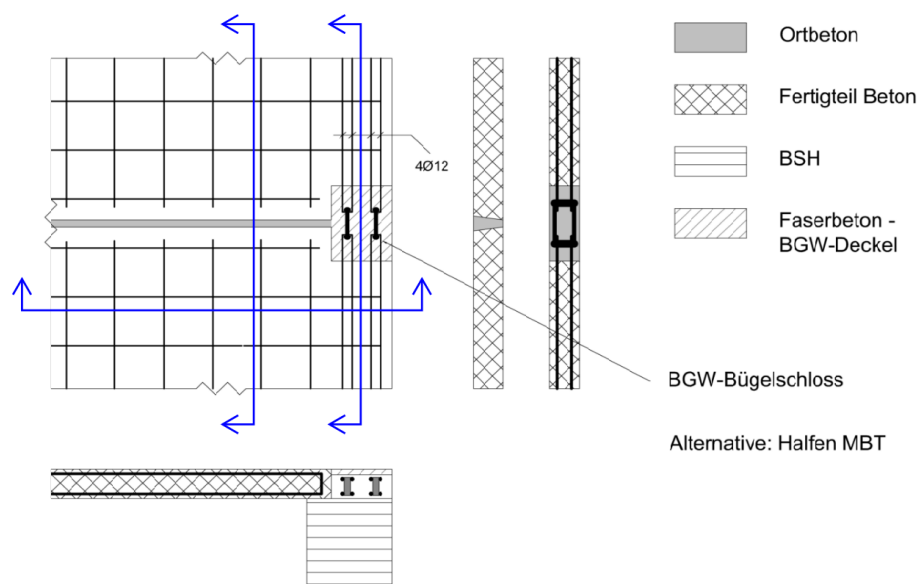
Grundriss und Schnitte: Kopplung der Deckenelemente durch Koppellelemente für die Bewehrung
